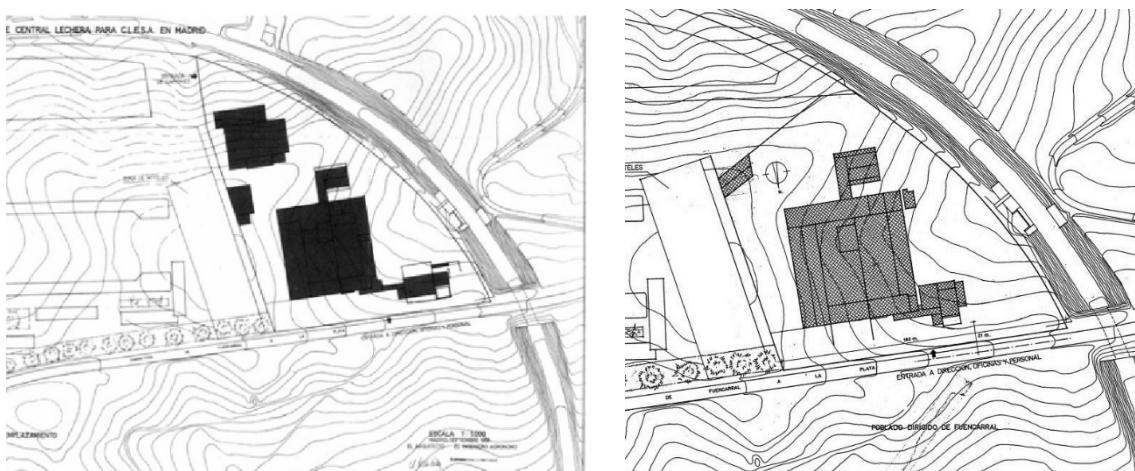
Plantas de situación: prevista en el proyecto de 1958 (visado 1961) y de la parcela inicial de 1961. Archivo Fundación A. de la Sota.
